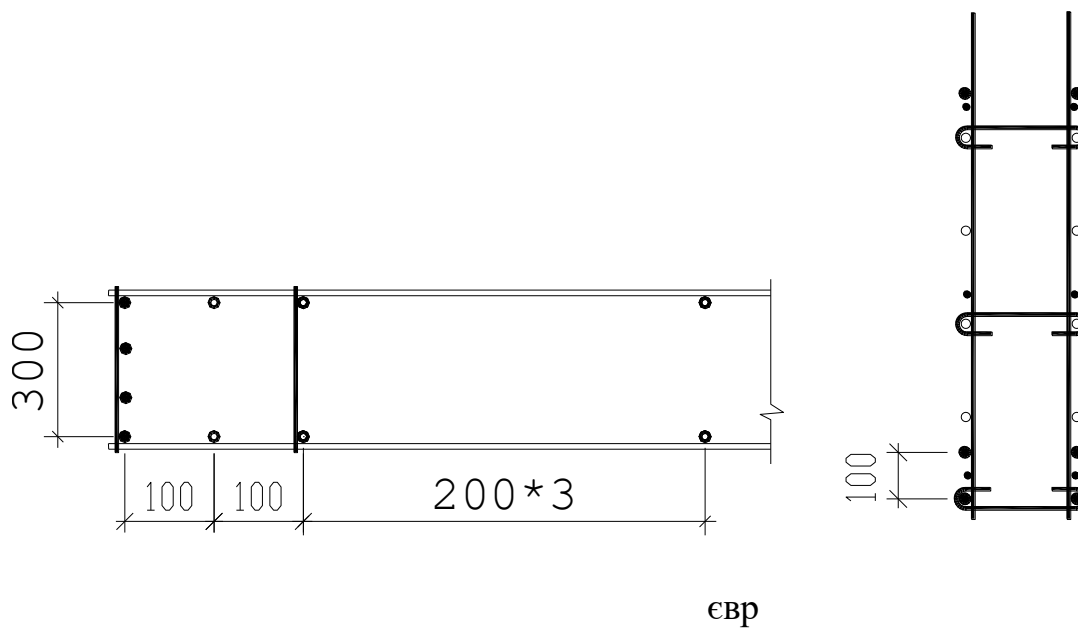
Горизонтальна (а) і вертикальна на дверях (b) Секції посилення стіни С3/4
